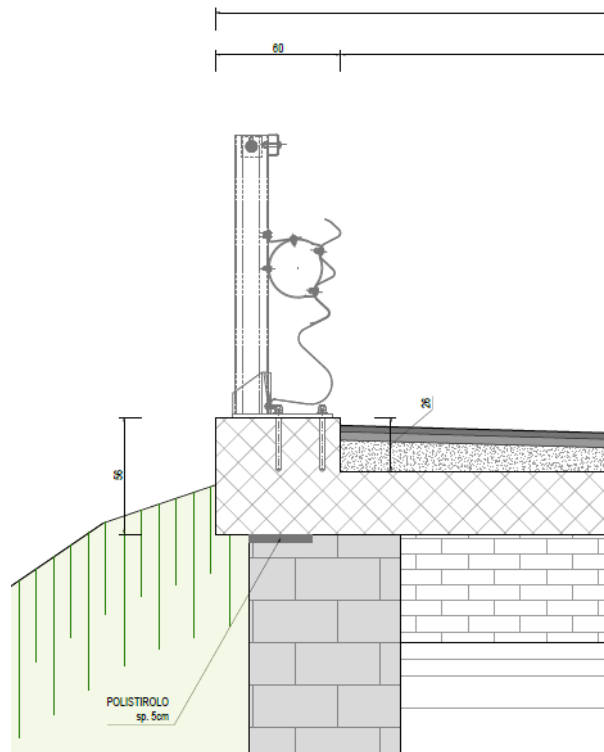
Dettaglio nuovo cordolo e parapetto lato ovest
